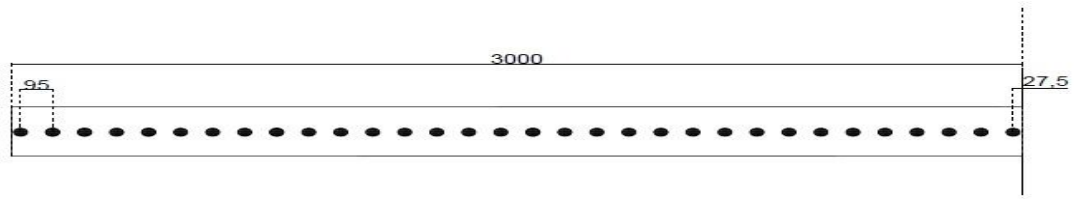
Nombre de connecteurs par demi portée & espacement dans la poutre principale
